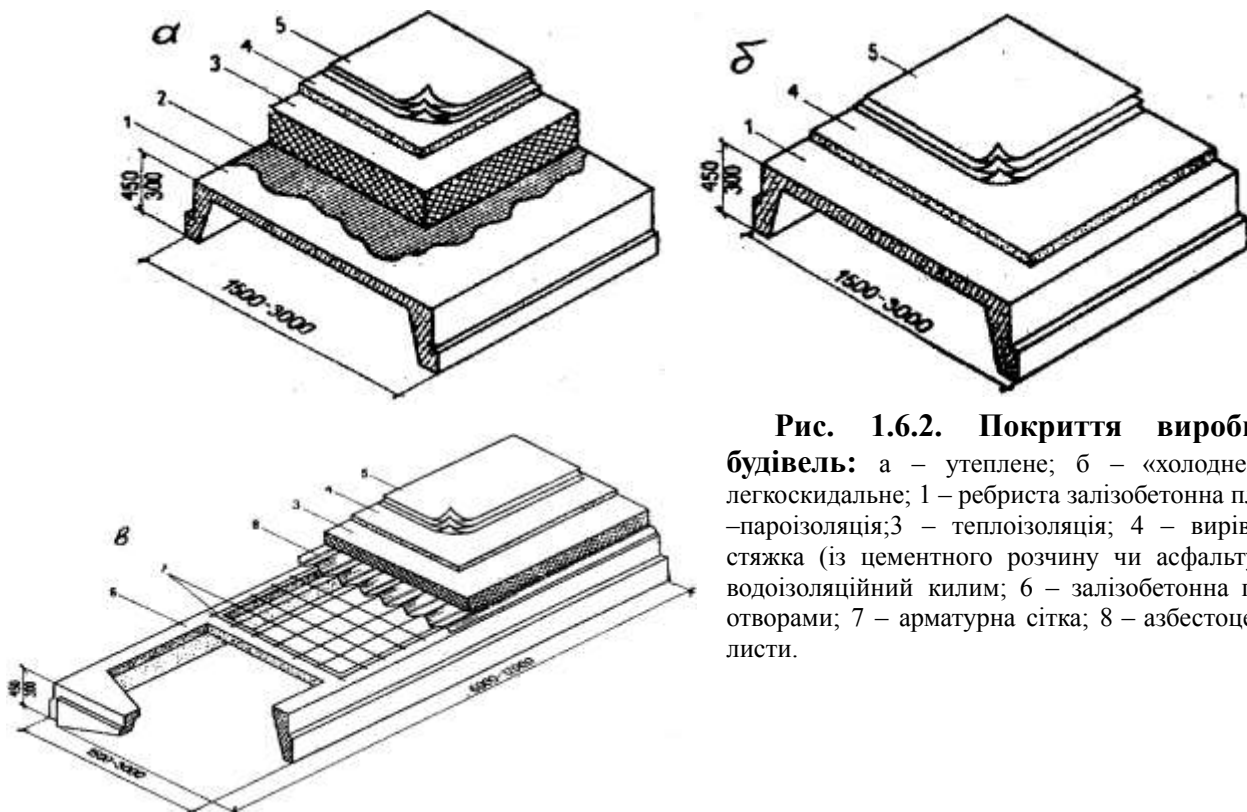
Покриття виробничих будівель: а — утеплене; б — «холодне»; в — легкоскидальне; 1 — ребриста залізобетонна плита; 2 — пароізоляція; 3 — теплоізоляція; 4 — вирівнююча стяжка (із цементного розчину чи асфальту); 5 — водоізоляційний килим; 6 — залізобетонна плита з отворами; 7 — арматурна сітка; 8 — азбестоцементні листи.
